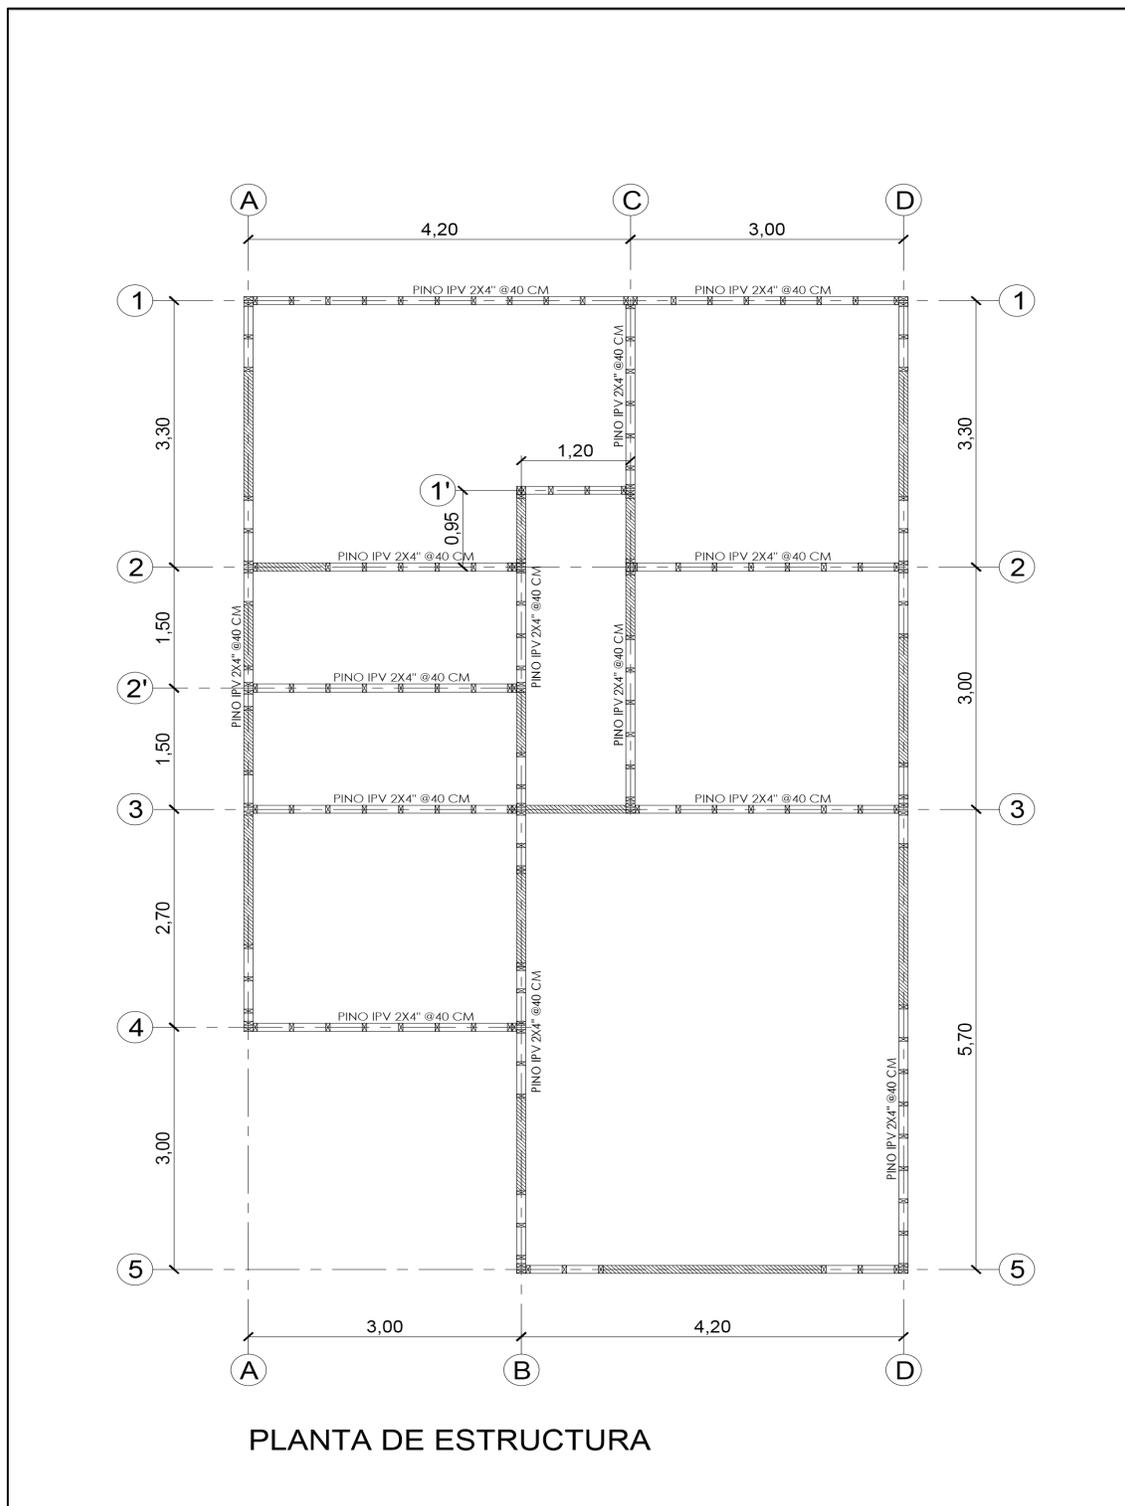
Planta de estructuras modelo entramado de madera 2x4"
